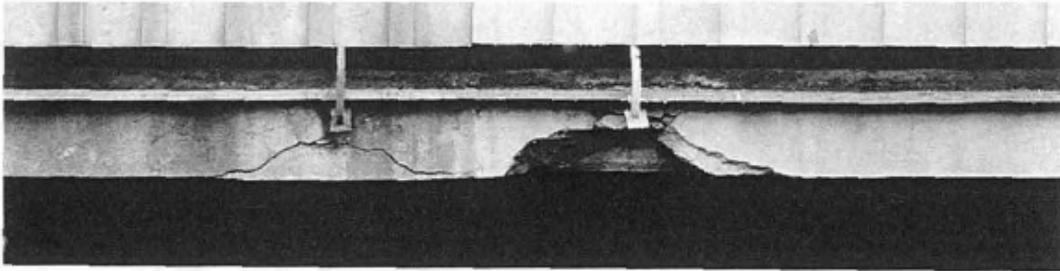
Schaden : Betonabplatzung Betondecke, aus HEINRICH [31]
